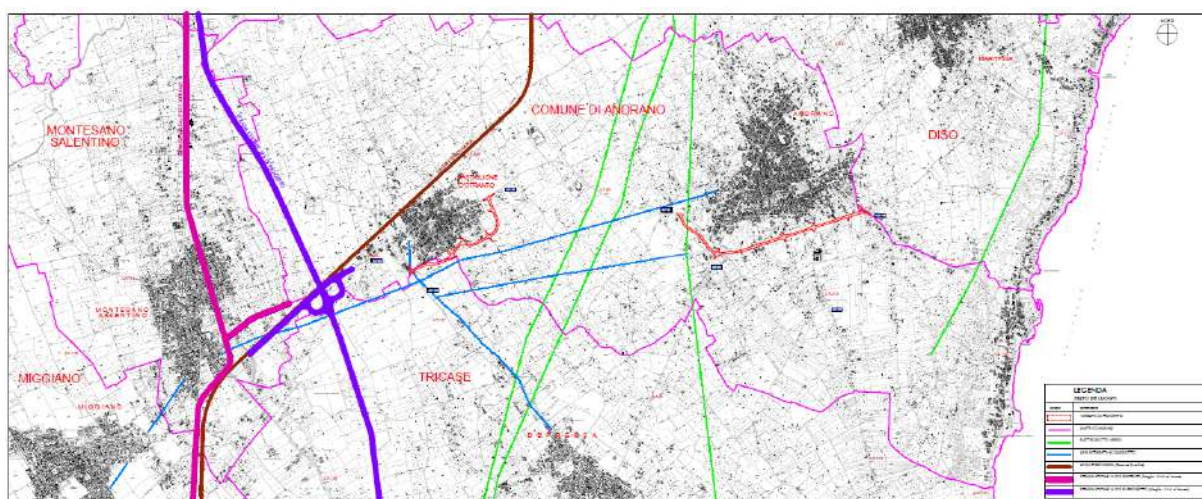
Planimetria generale dei due interventi. In rosso sono evidenziate le nuove viabilità
